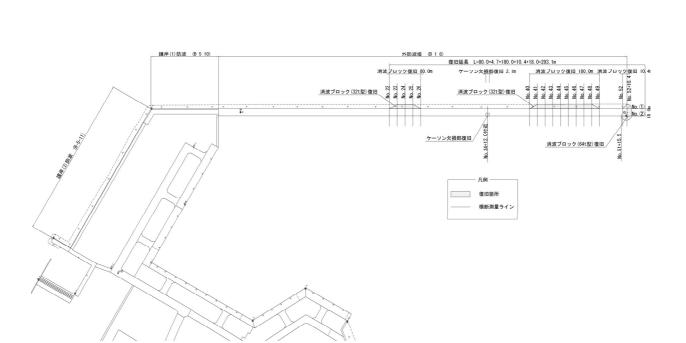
No.7 諏訪下地区_外防波堤の平面図(復旧後)
